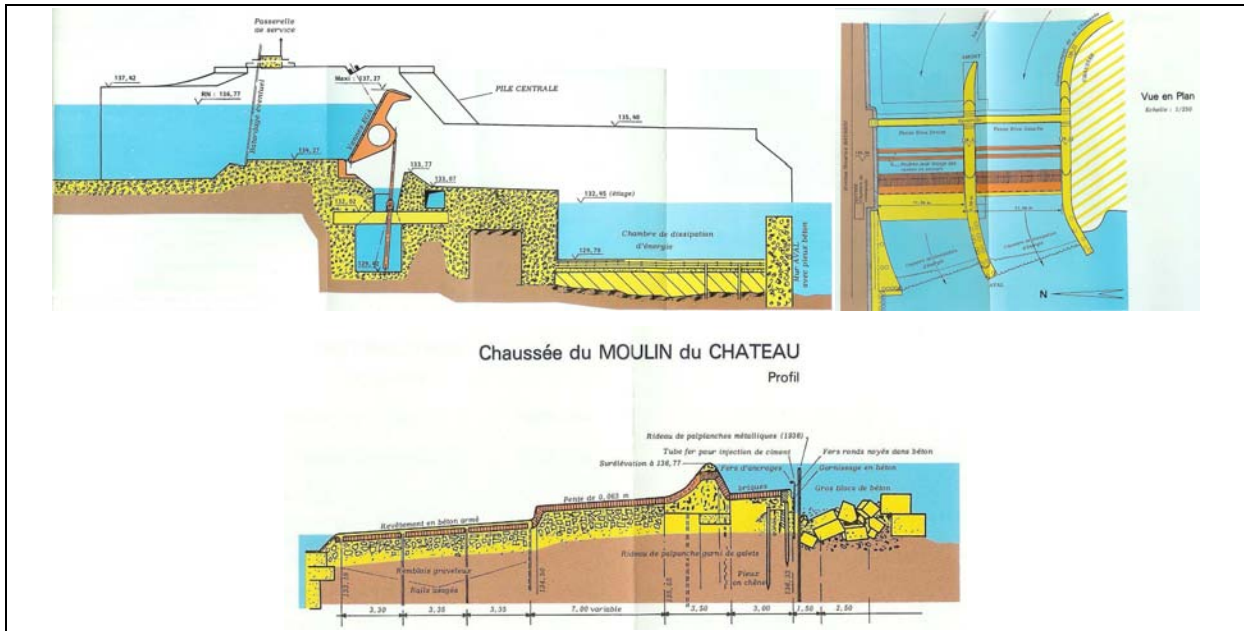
Caractéristiques de la chaussée du Moulin du Château (plan des vannes en haut et profil en long de la chaussée en bas)
